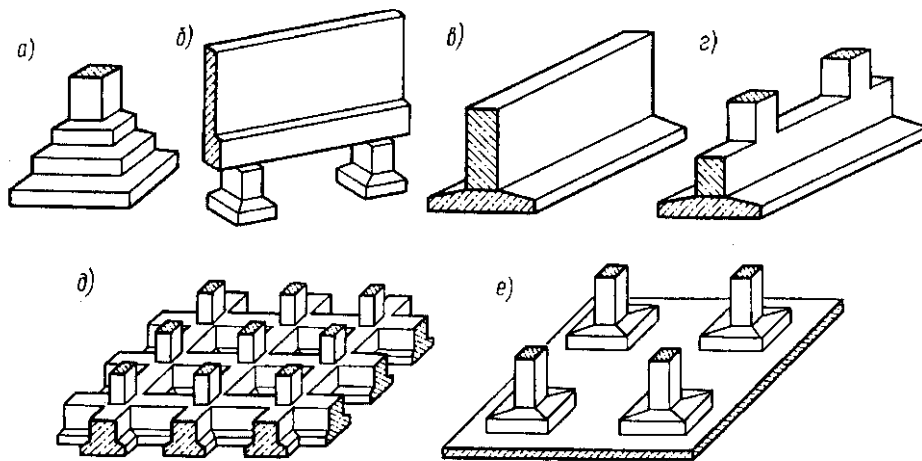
Типи фундаментів мілкого закладення для промислового та цивільного будівництва:
